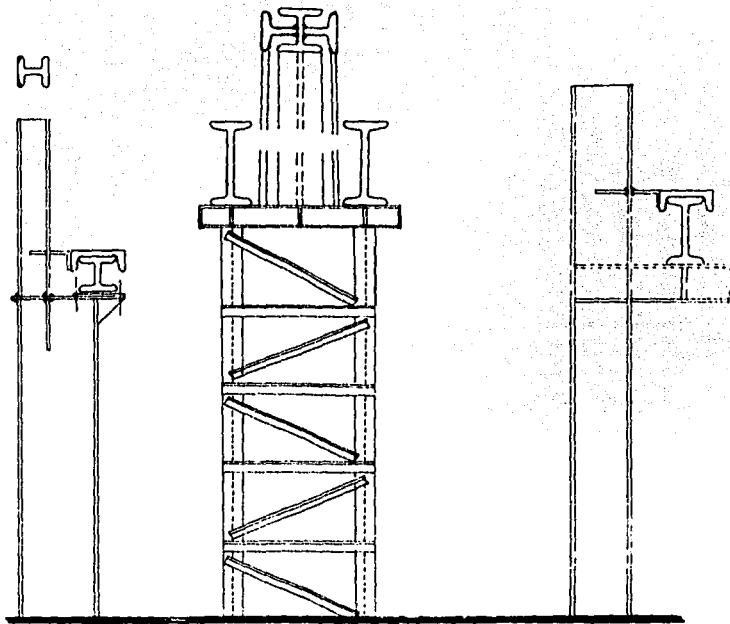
Arreglo típico de columnas para soportar traves carril y techumbre
